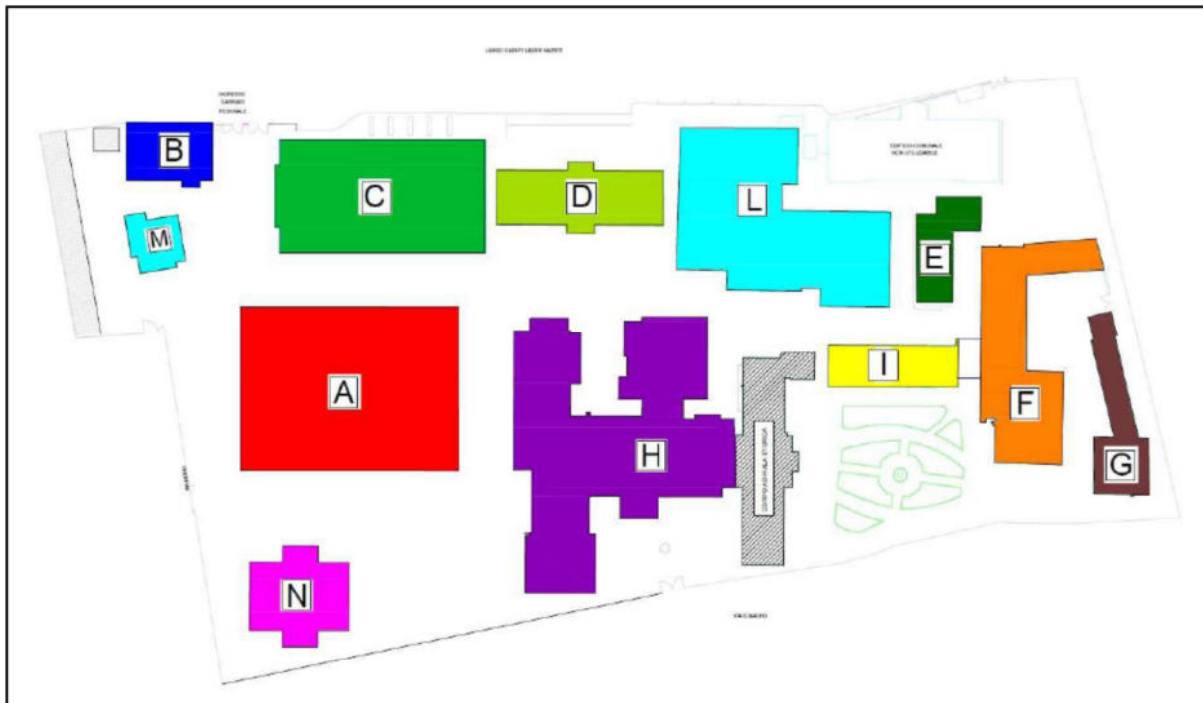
| Planimetria generale dello stato attuale del Plesso Ospedaliero
